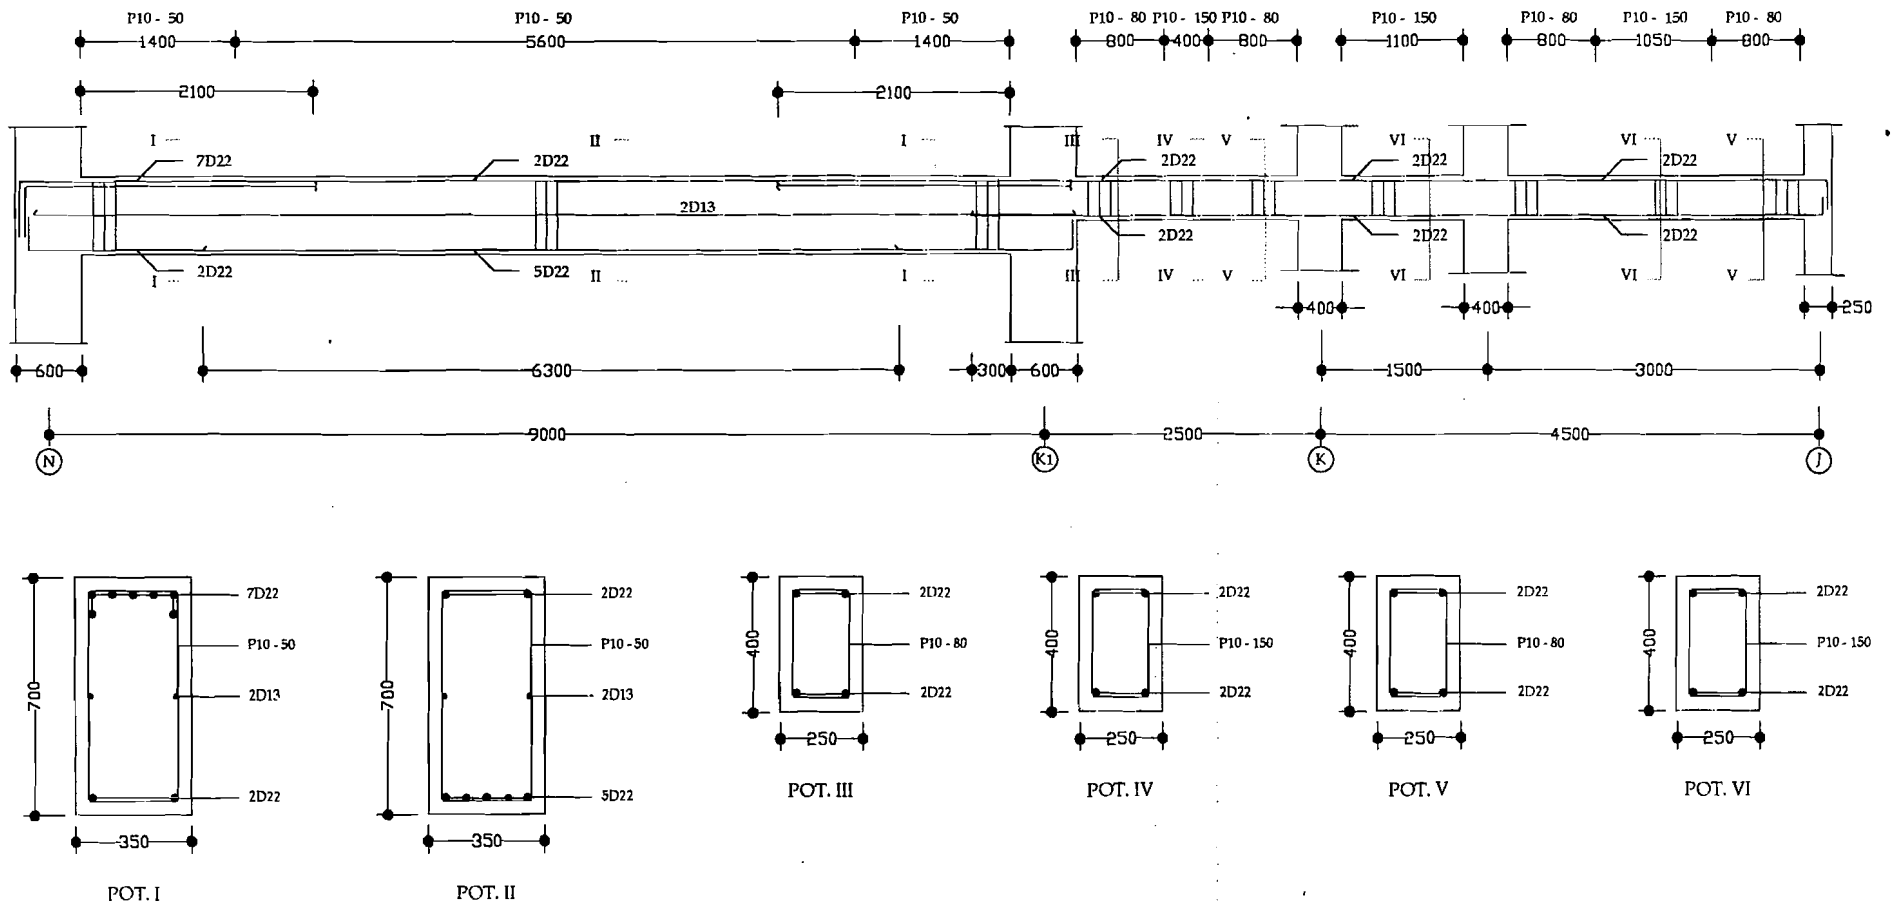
Denah Rencana Balok Induk Lantai 1
